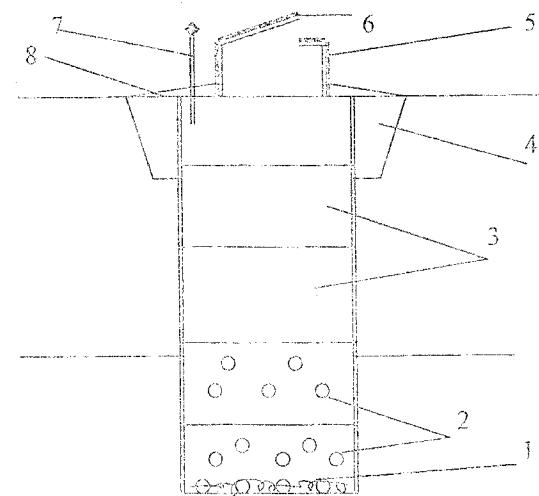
Схема шахтного колодца: 1 – слой гравия и гальки; 2 – водоприемные отверстия; 3 – железобетонные кольца; 4 – глиняный замок; 5 – оголовок; 6 – крышка; 7 – вентиляционная труба; 8 – каменная отмостка
